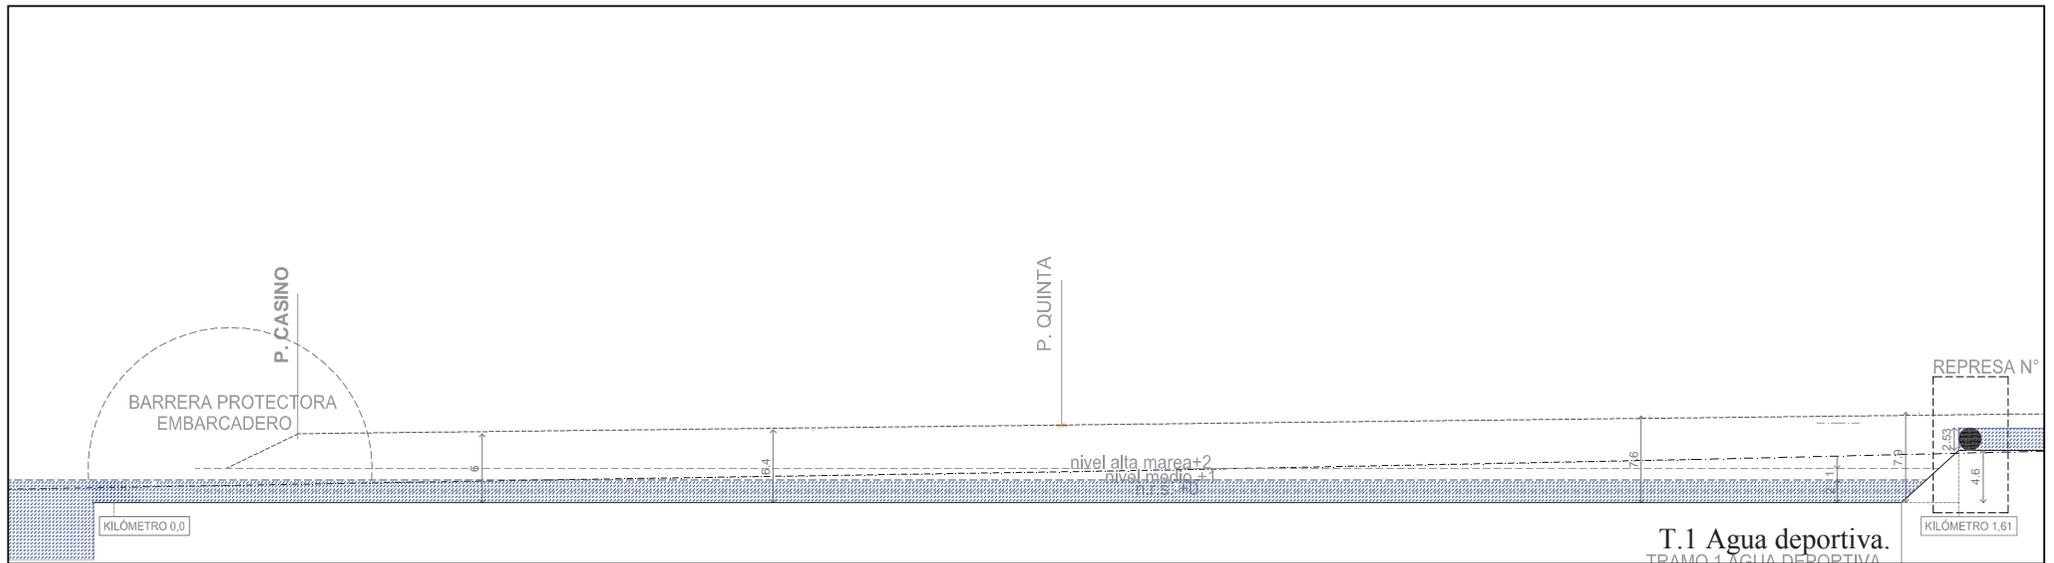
Planos Homero Latorre. Corte longitudinal tramos 1, pendiente cero, lecho natural. Su límite oriente es la represa inflable con tramo 2 y el poniente con el océano Pacífico.
